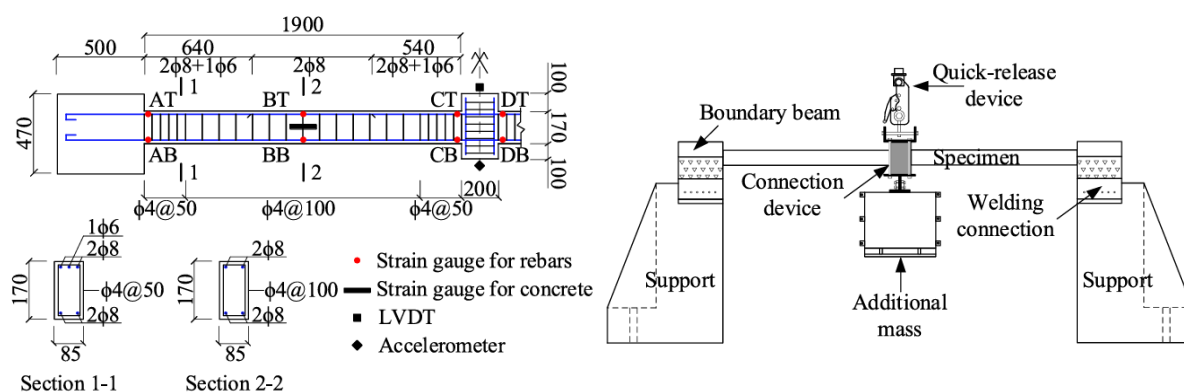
Dettagli d'armatura (quote espresse in mm) degli elementi strutturali e rappresentazione della modalità di esecuzione dei test dinamici
